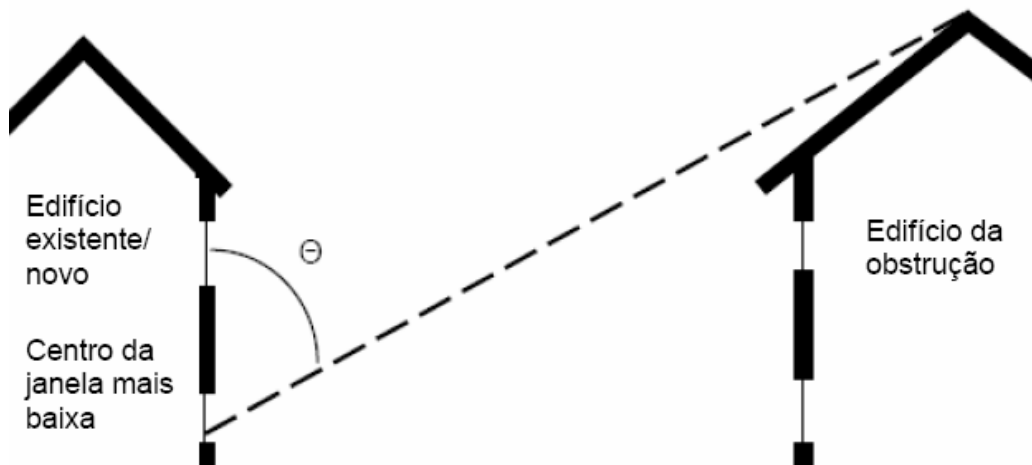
Secção no plano perpendicular a fachada principal do edifício [10].
